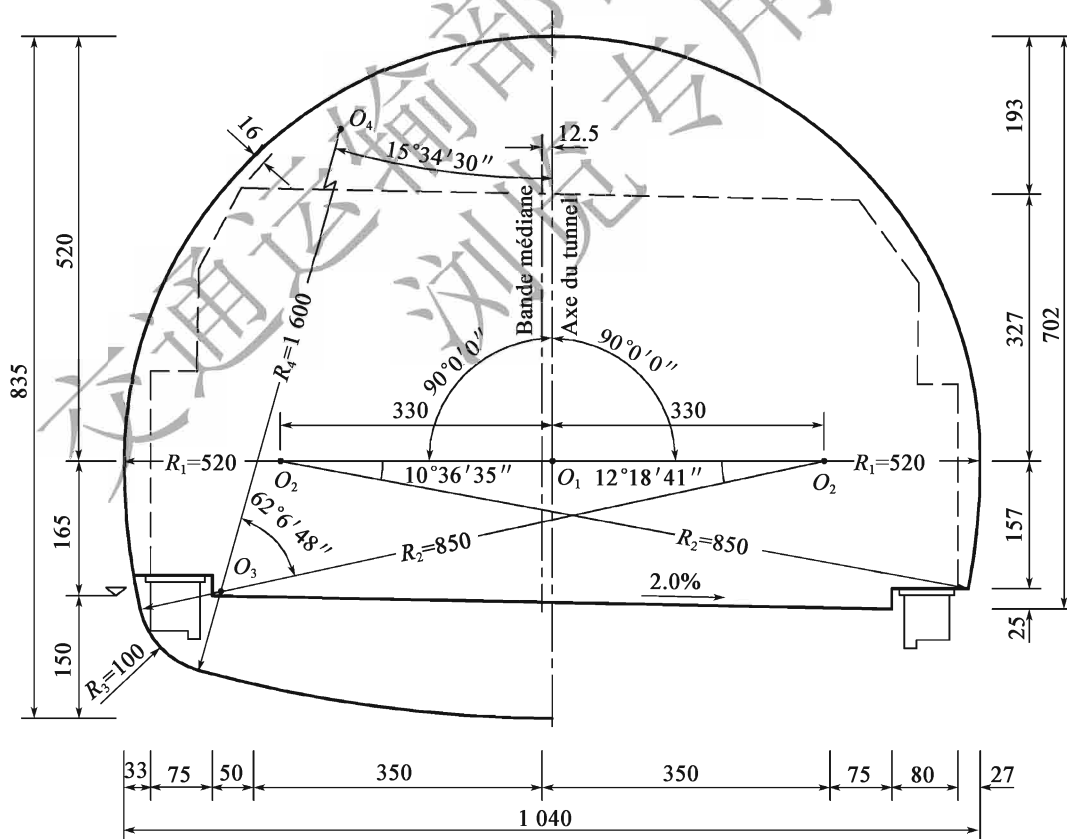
Gabarit du tunnel routier de première classe à deux voies(60km/h) (unité:cm)
